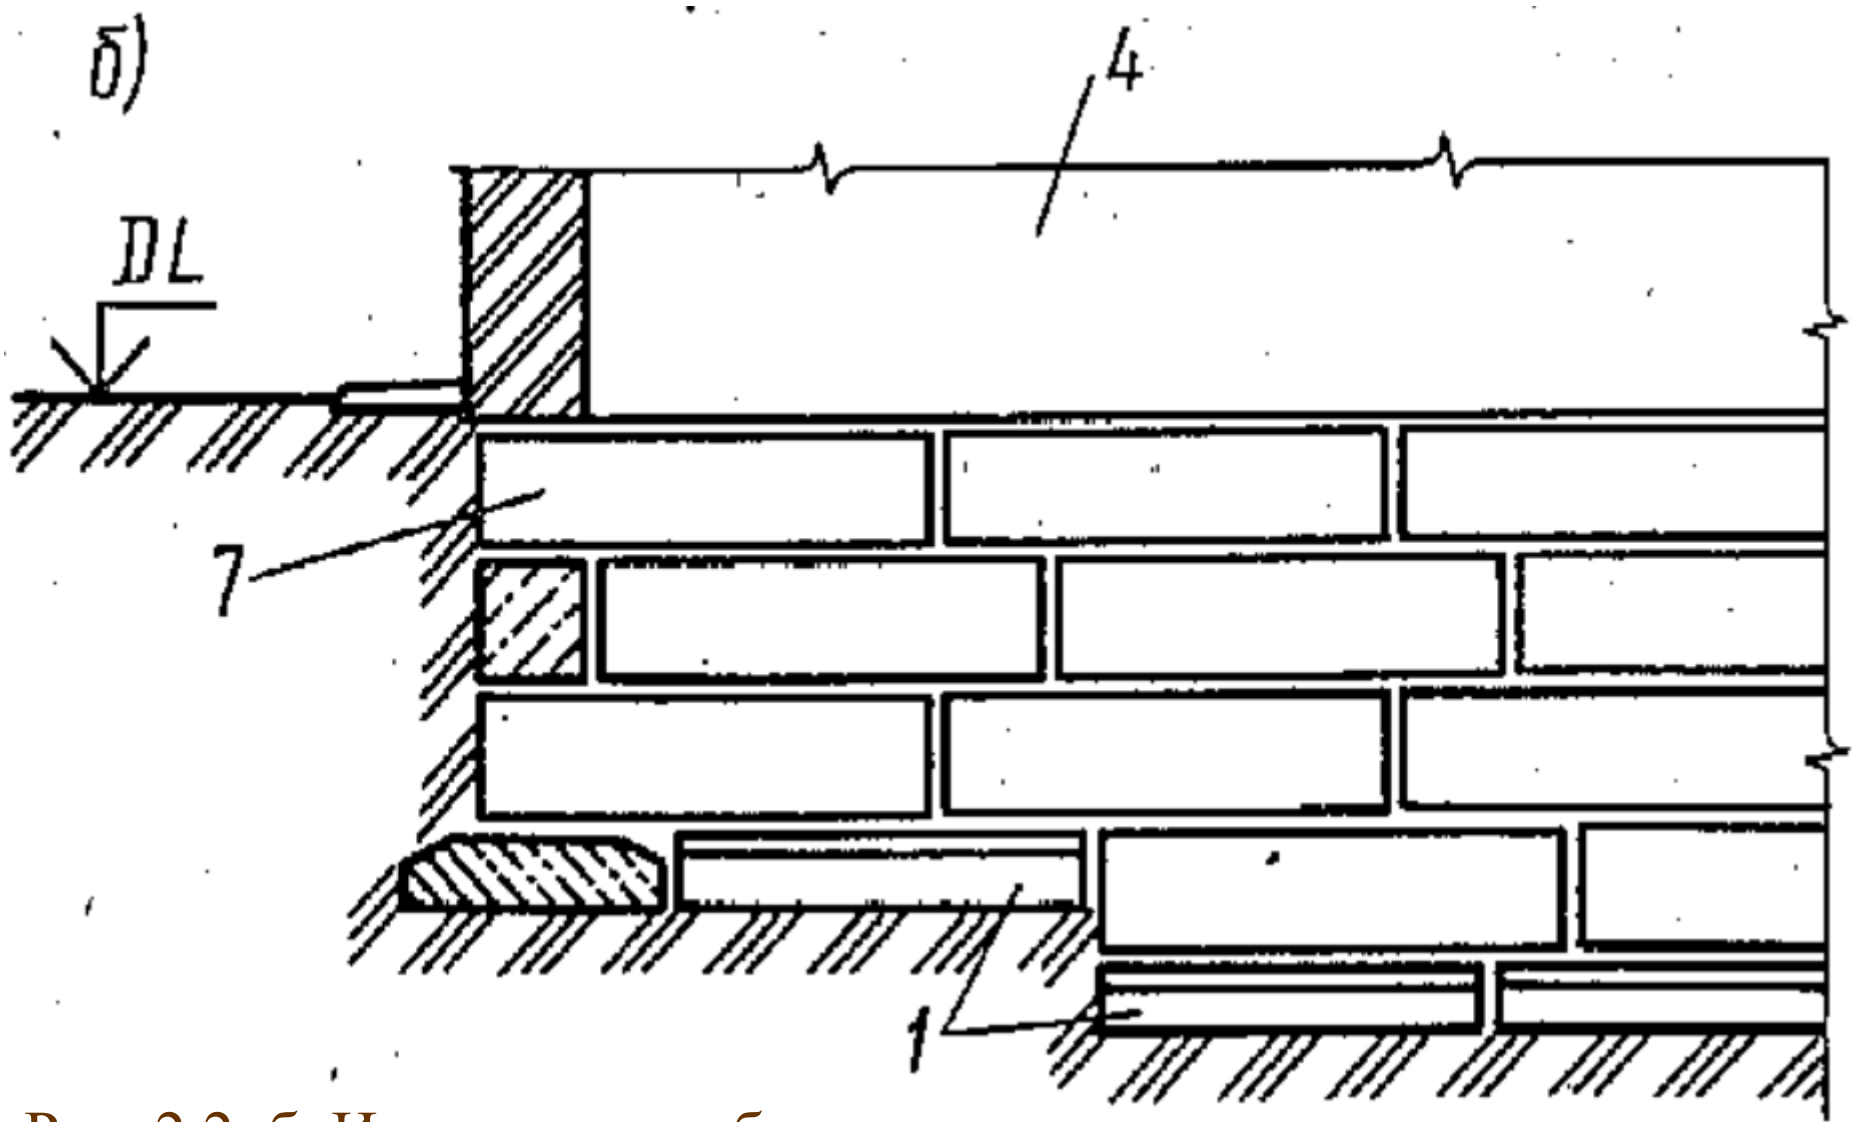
, б. Изменение глубины заложения ленточного фундамента; 1 — фундаментные плиты; 4 — стена здания; 7 — стеновые блоки
